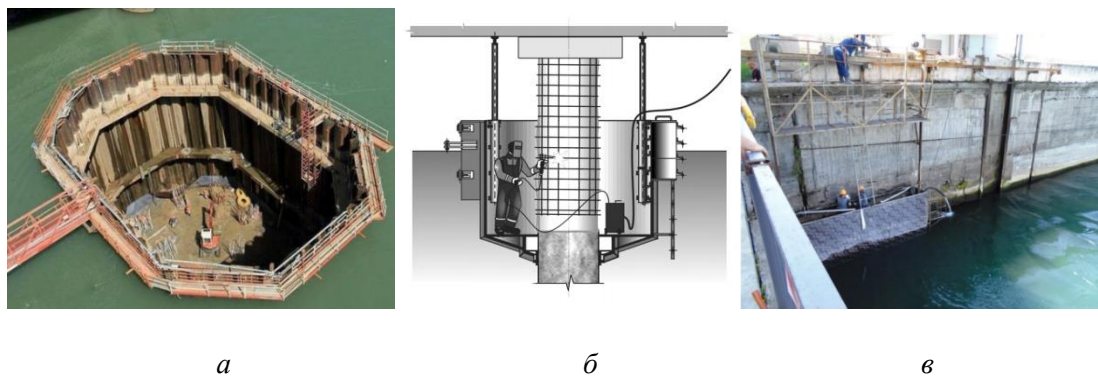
Примеры заградительных приспособлений для обеспечения сухой зоны: *а* – гермокамера; *б* – кессон; *в* – коффердам
